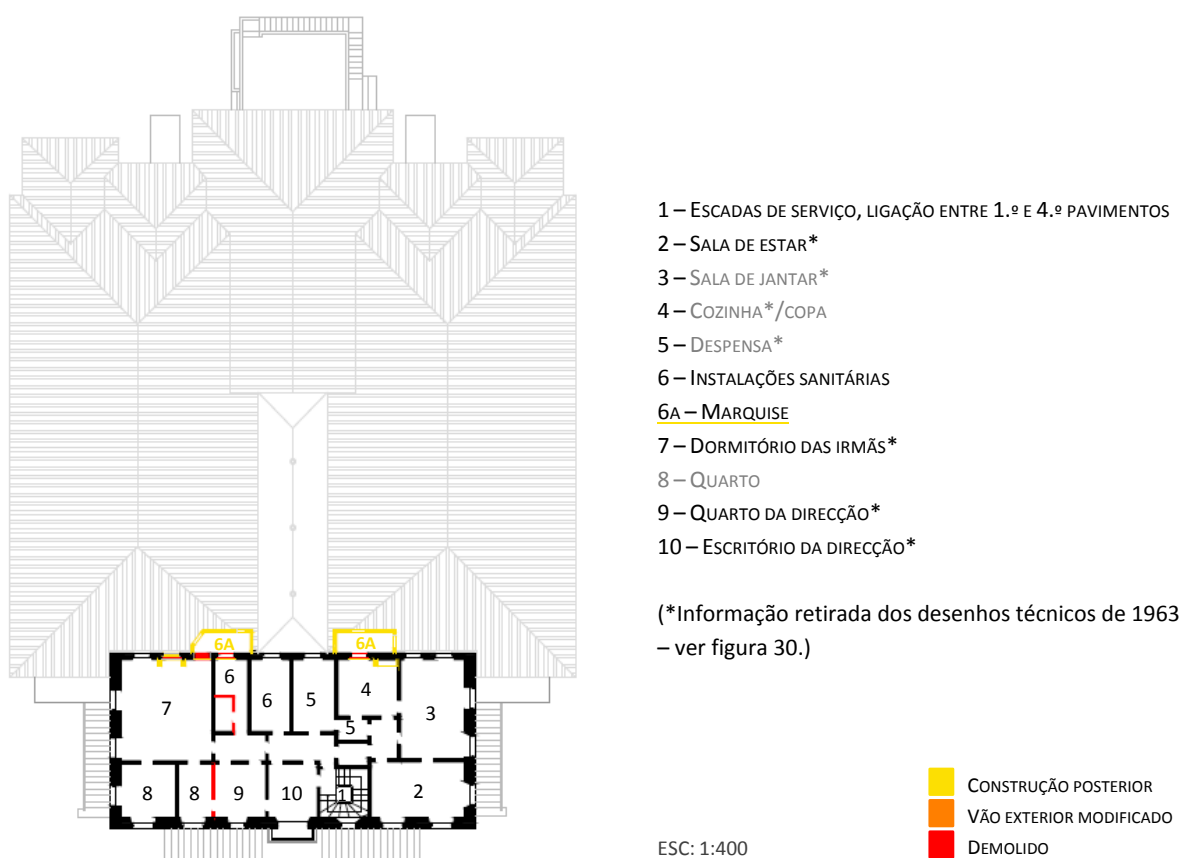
Proposta de reconstituição do 4.º pavimento, em 1916
